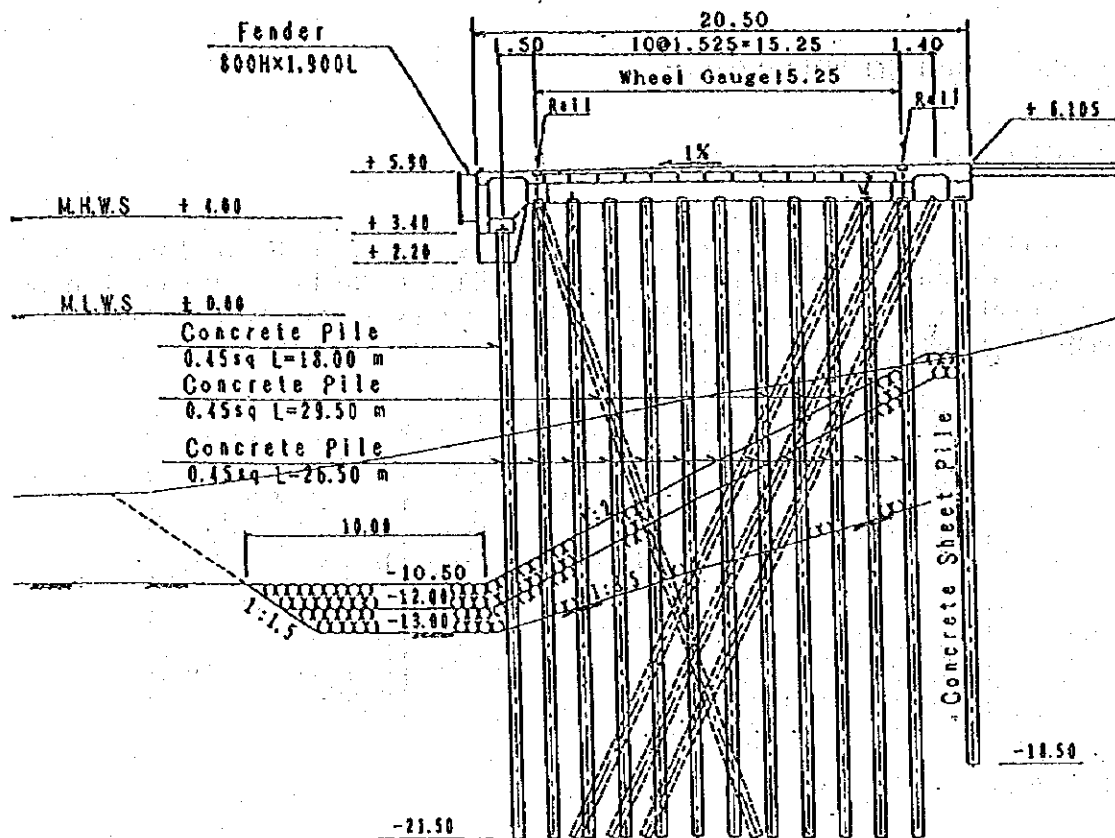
Corte Típico del Atracadero de Contenedores
